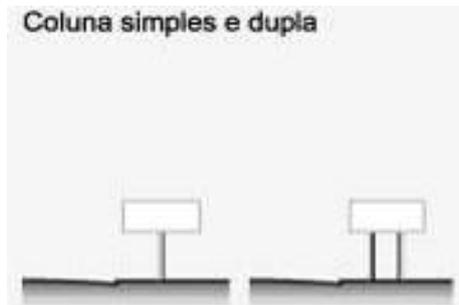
Tipos de suportes para placas de sinalização verticais em laterais ou sobre a rodovia.
